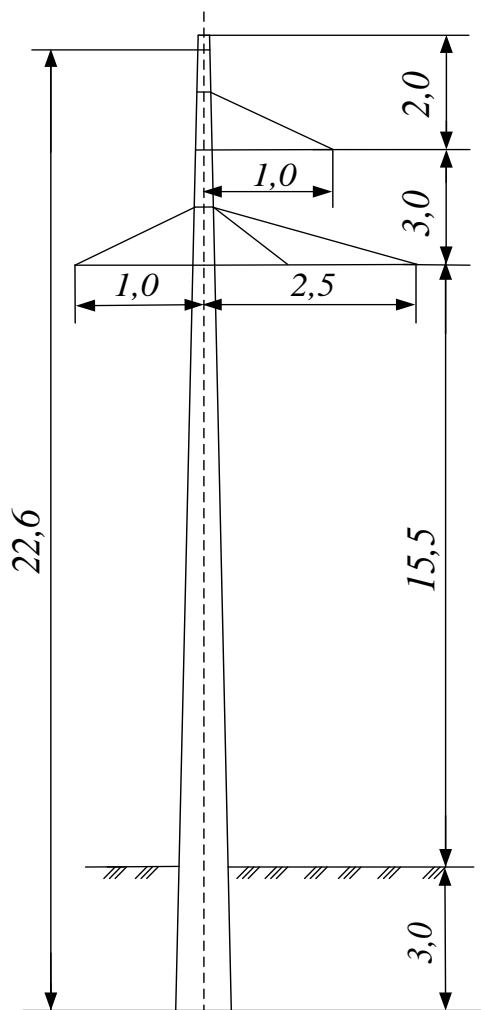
Проміжна залізобетонна опора типу ПБ 35 – 1
